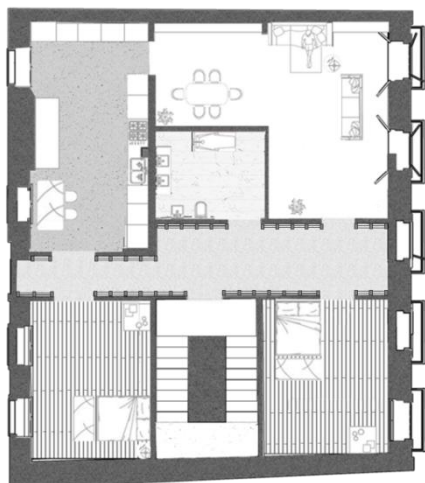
Planta de apartamento com organização espacial proposta e possível disposição de mobiliário, criação do autor.
